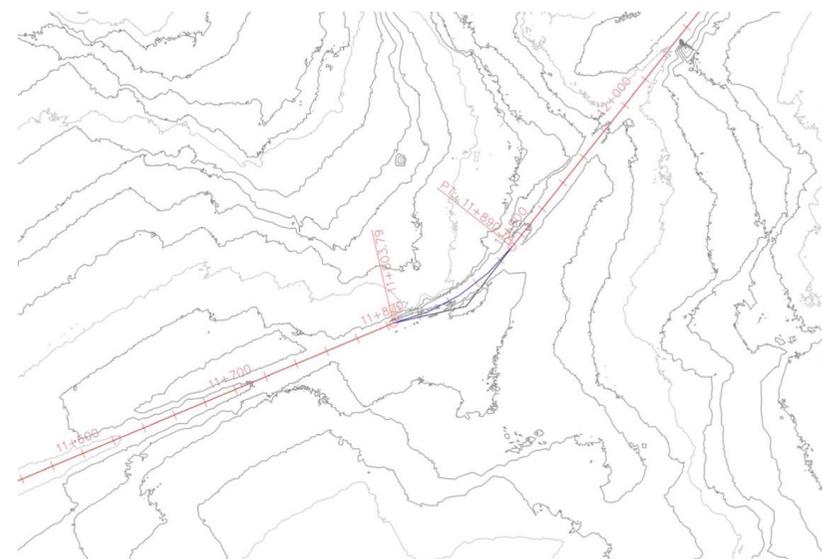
Pantallazo de Civil 3D con niveles del terreno y trazado de la carretera en planta (Curva 1)
